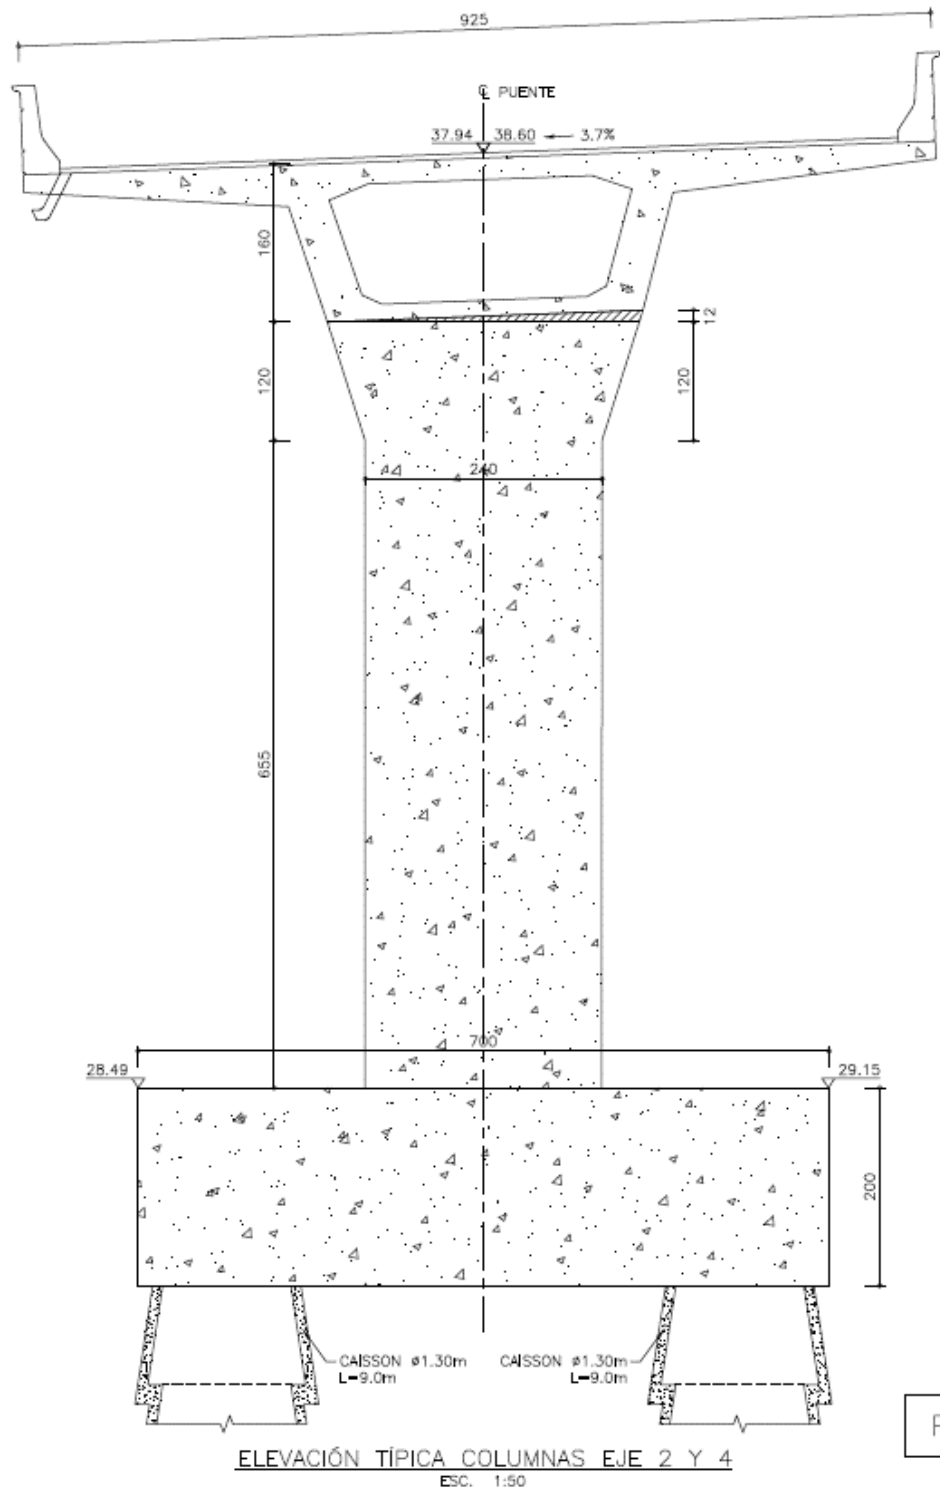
Geometría del apoyo eje 2 y 4 del puente vía a Minca.
